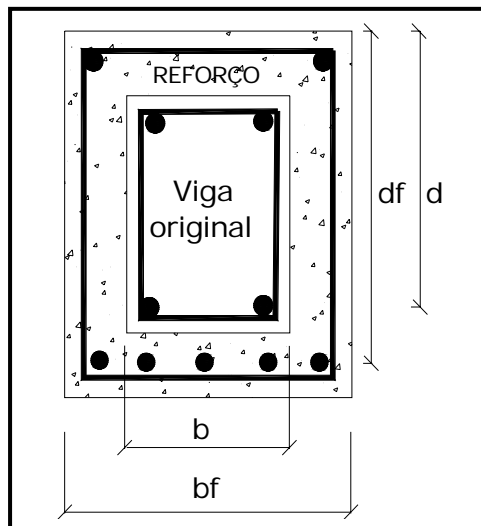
Seção típica das vigas reforçadas por encamisamento (adaptado de Altun, 2004).
